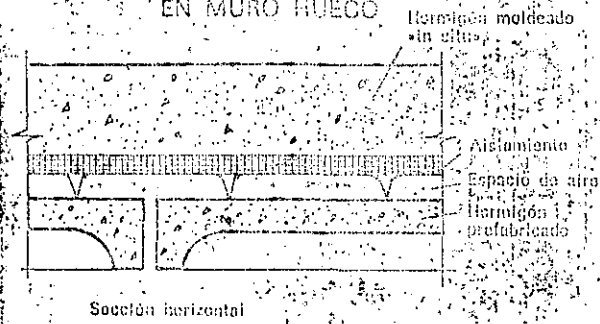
RECUBRIMIENTOS PREFABRICADOS DE PILARES UTILIZADOS COMO ENCOFRADO
